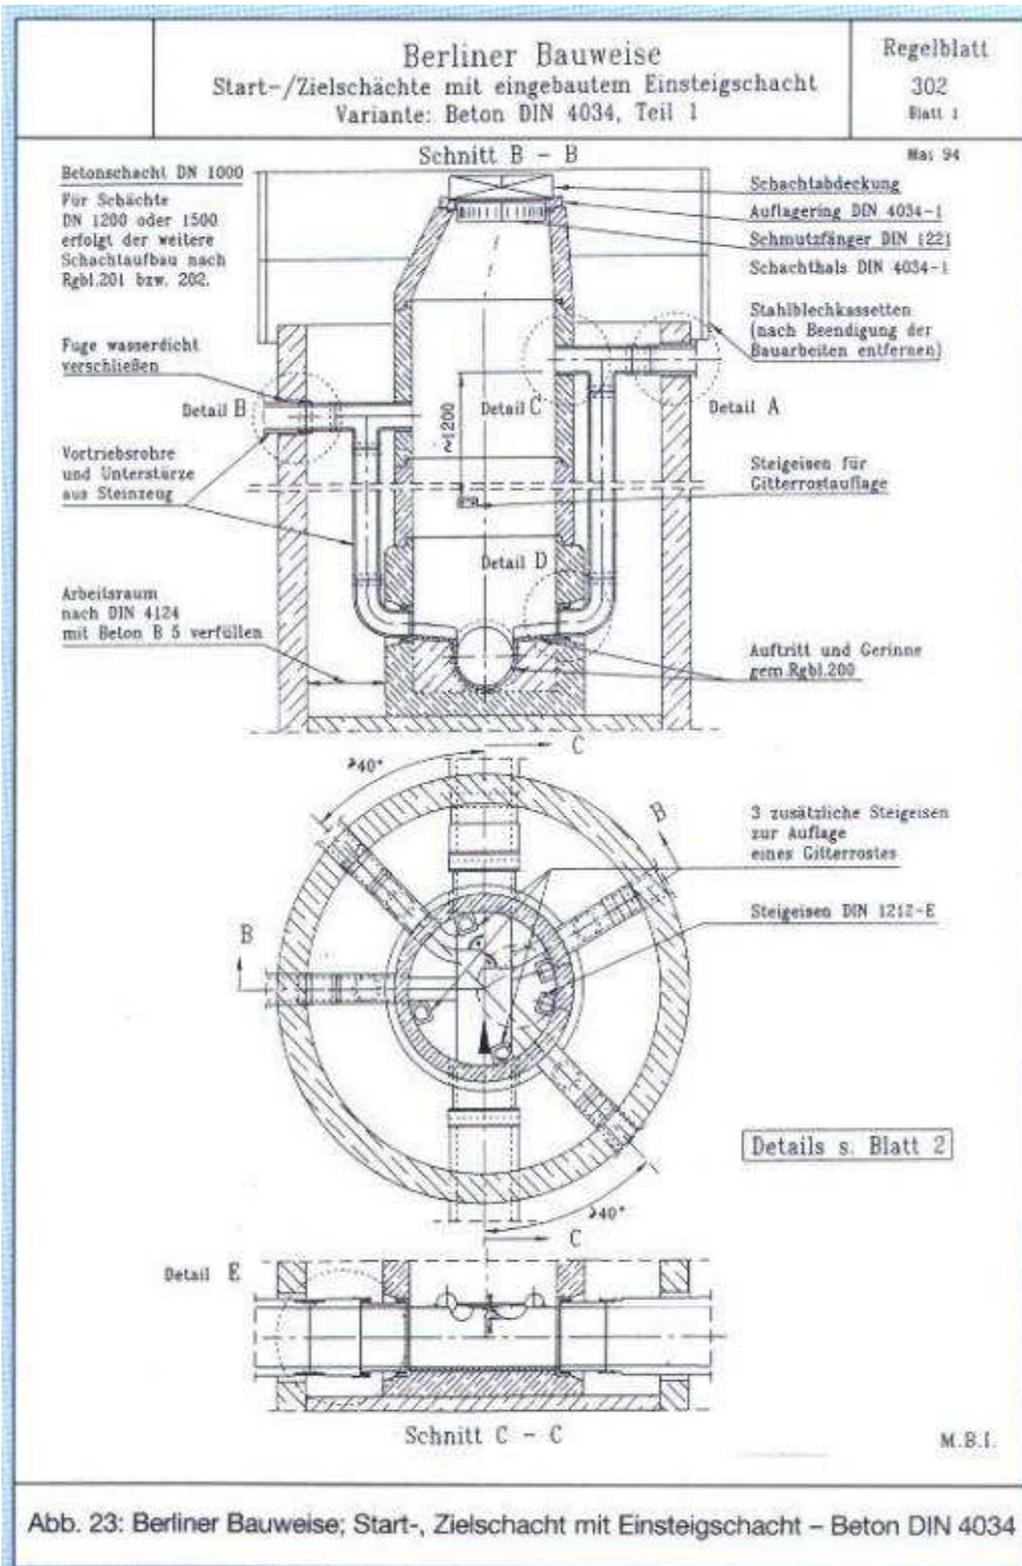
Berliner Bauweise; Start-, Zielschacht mit Einsteigschacht – Beton DIN 4034
